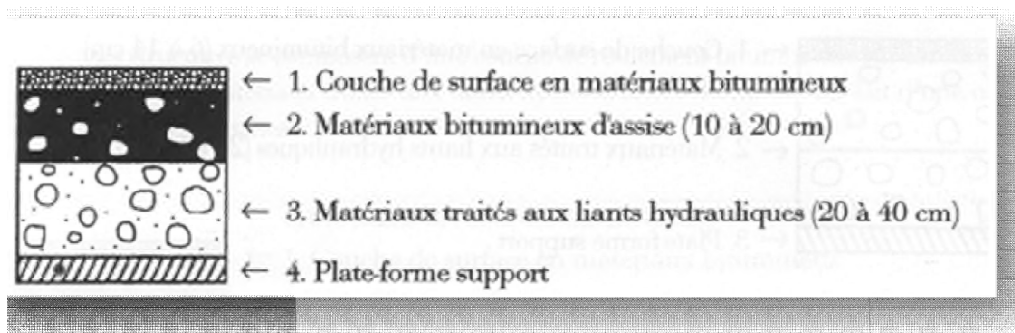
chaussées à structure mixte [LCPC, 1994] [1].
